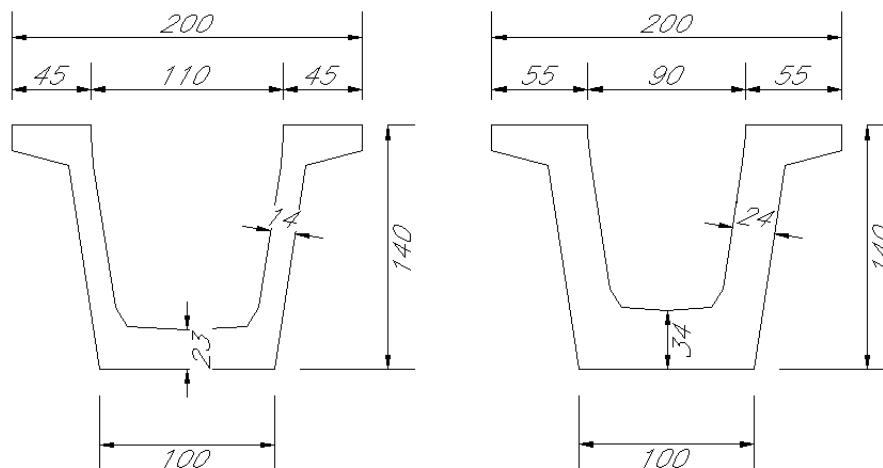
Sezioni in Fase 1 (cassoncino): sezione corrente e sezione di transizione - sezione di testata
